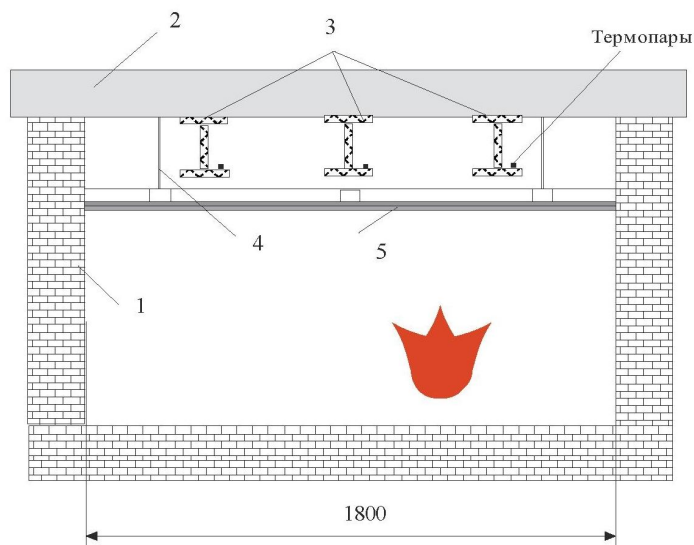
Схема испытаний подвесного потолка на огнестойкость: 1-печь; 2-перекрытие; 3-стальные несущие балки; 4-подвеска; 5-гипсокартонные плиты
